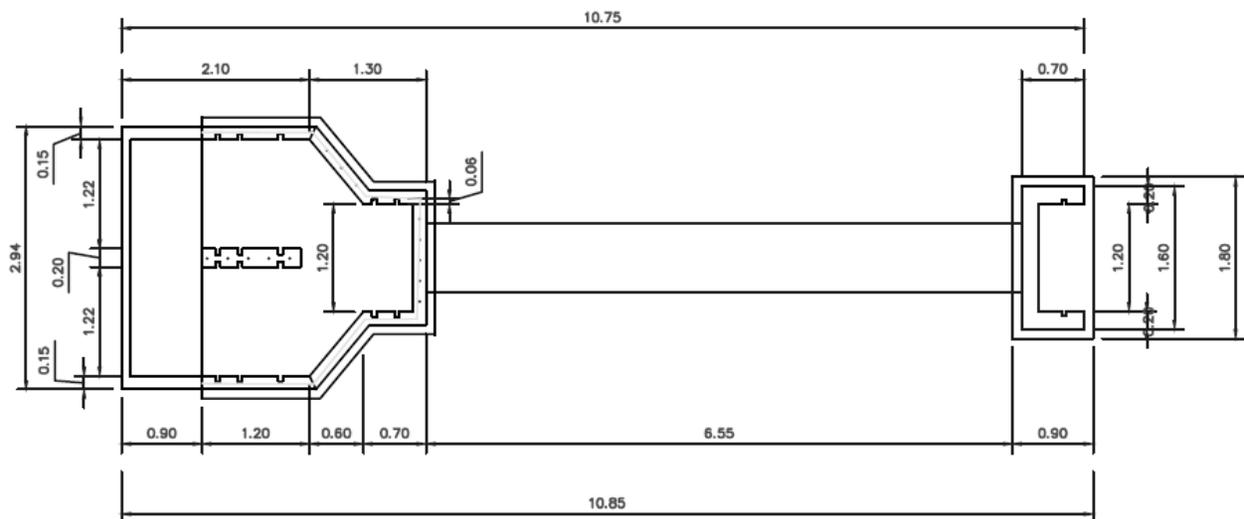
Planta Estructura de Cajas de Entrada, Acuícola Atón, S.A. 2022.
